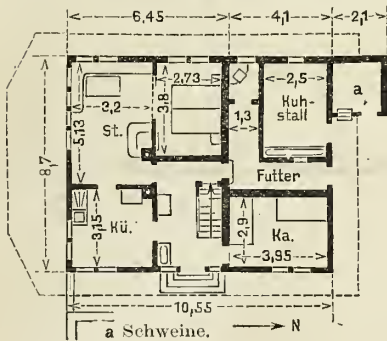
Grundriß zu Abb. 1. Einfamilienhaus.
